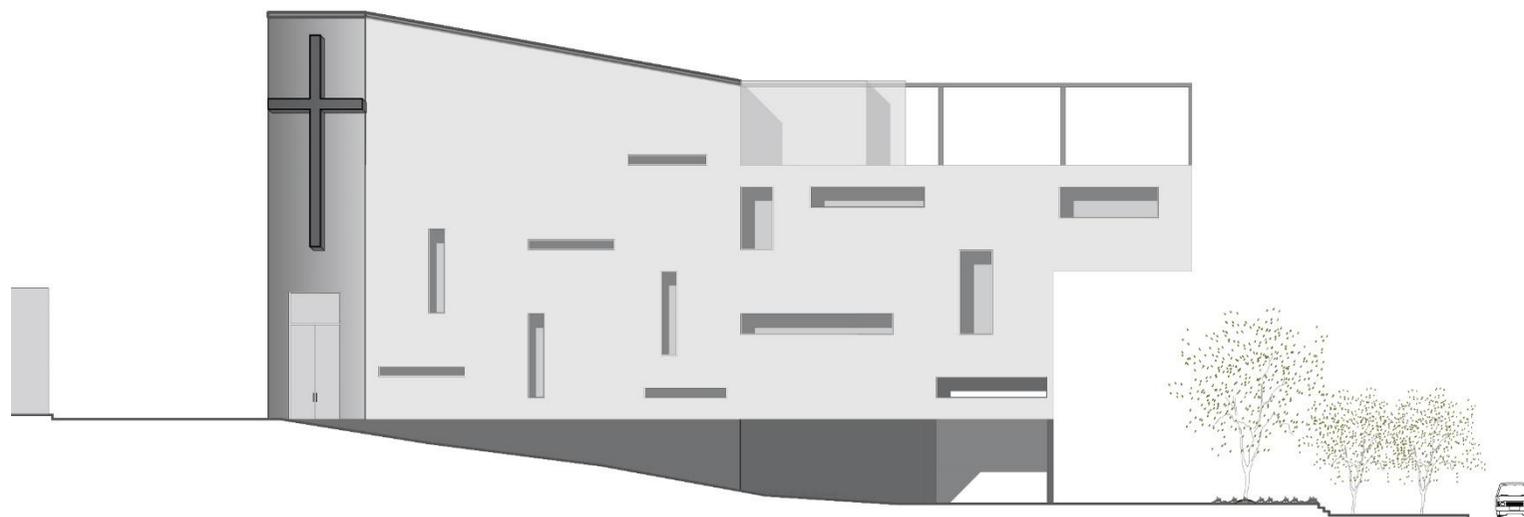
Fachada lateral izquierda. Fuente: Propia.
